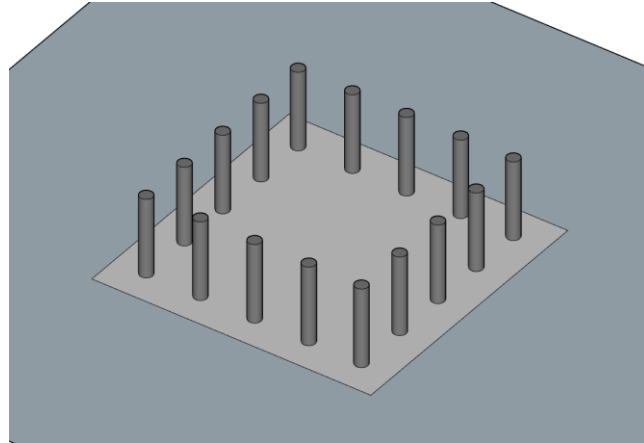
| Anclajes colocados y hormigonado de fundaciones
